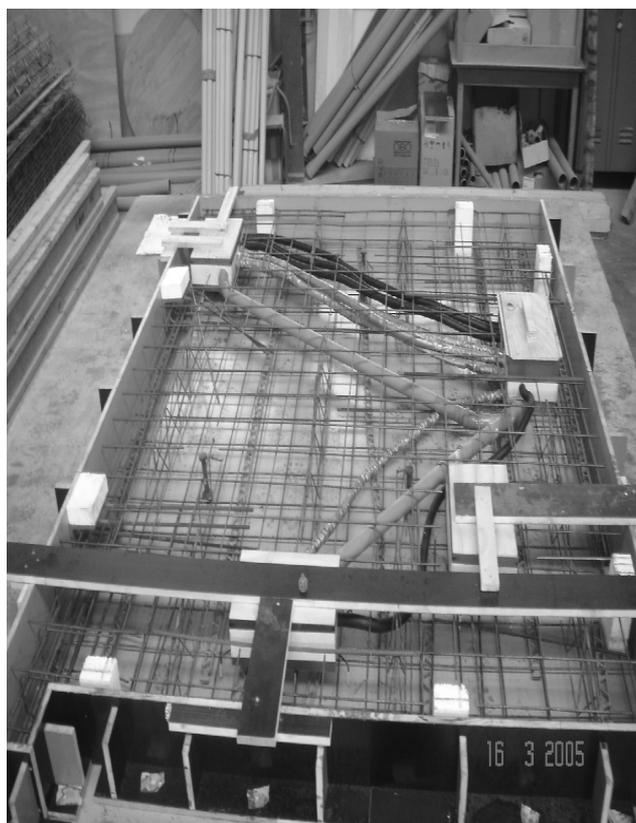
Fertigdeckenteilelement mit Einlagen kurz vor Betonierung im Werk.
